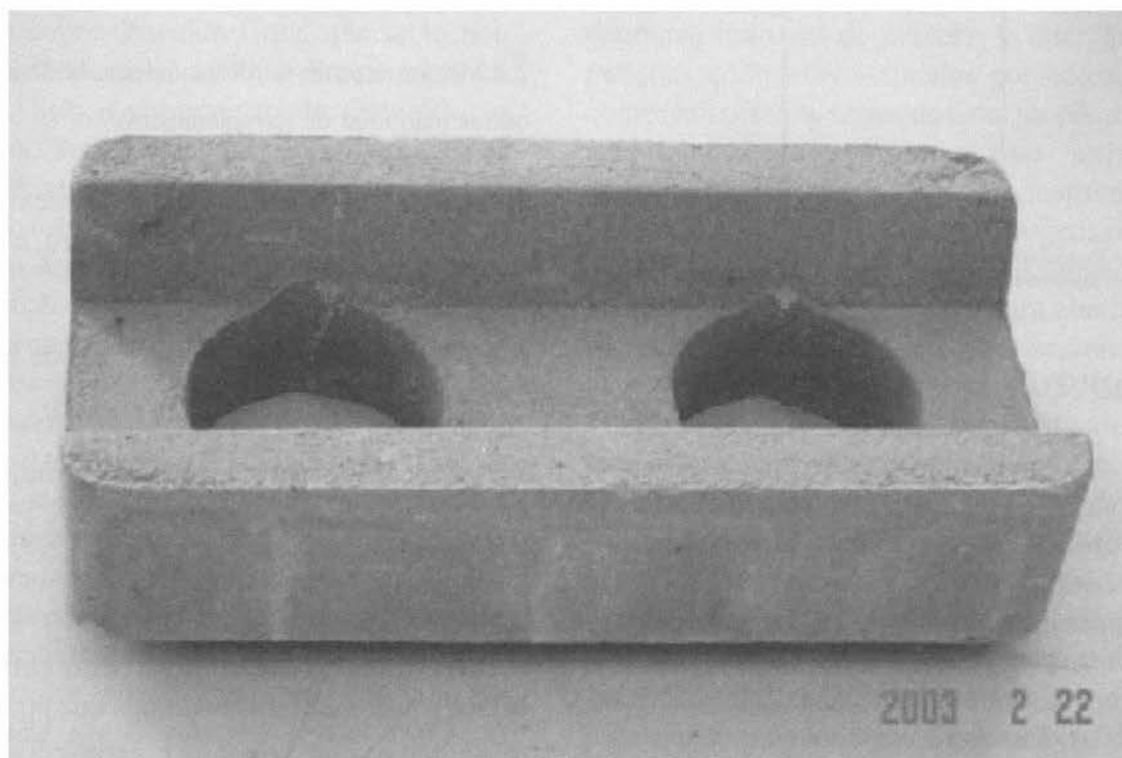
tijolo de solo-cimento tipo canaleta para a execução de vergas e cintas de amarração
